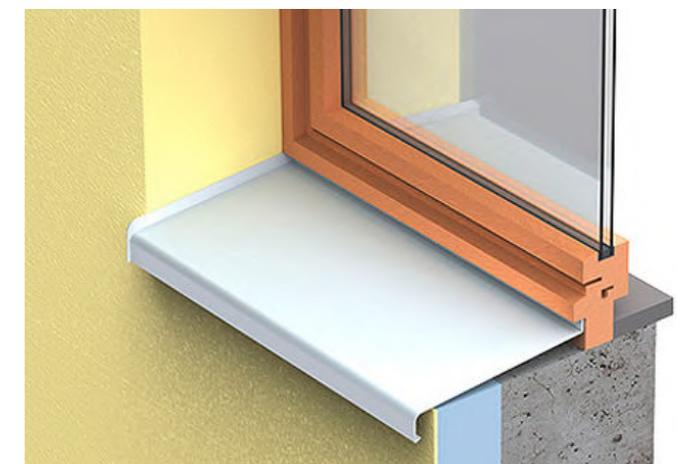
Davanzale in lamiera. Fonte: www.archiexpo.it
